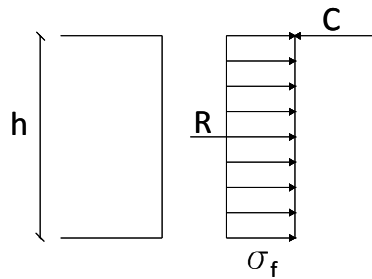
26. Distribución de tensiones de la sección tras la fisuración.
